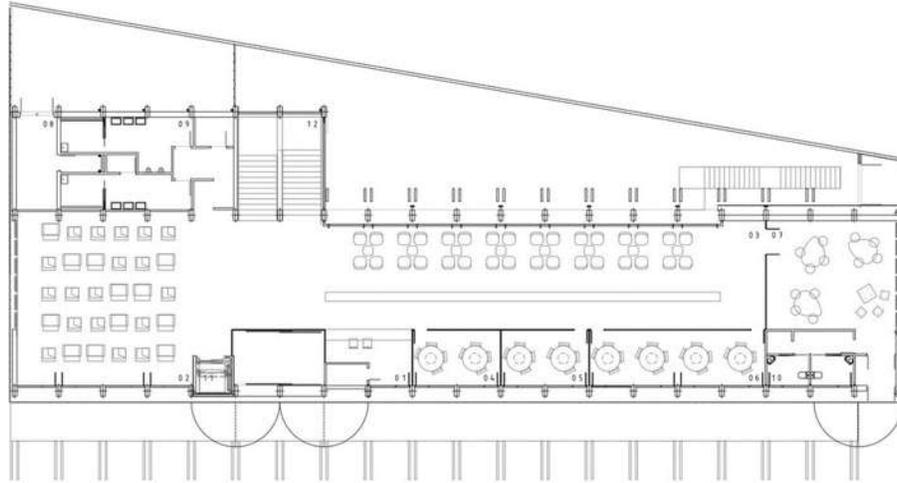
12 Planta Baja Biblioteca Comarcal Adolfo Suárez Ronda.
